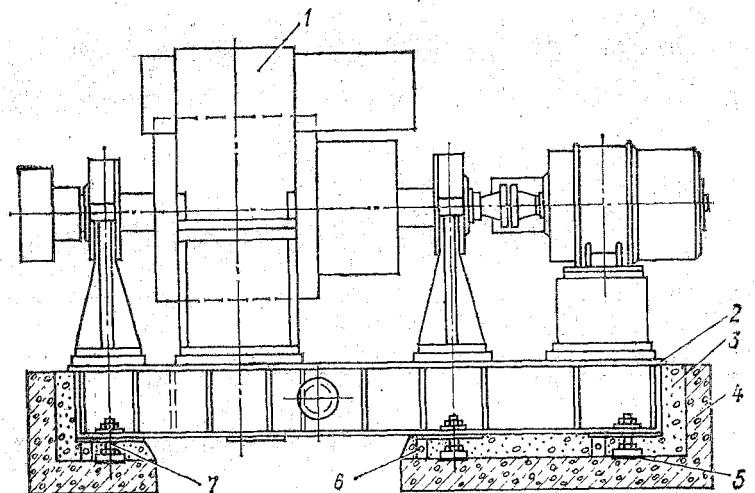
Крепление агрегата к бетонному фундаменту с помощью опорных узлов:
